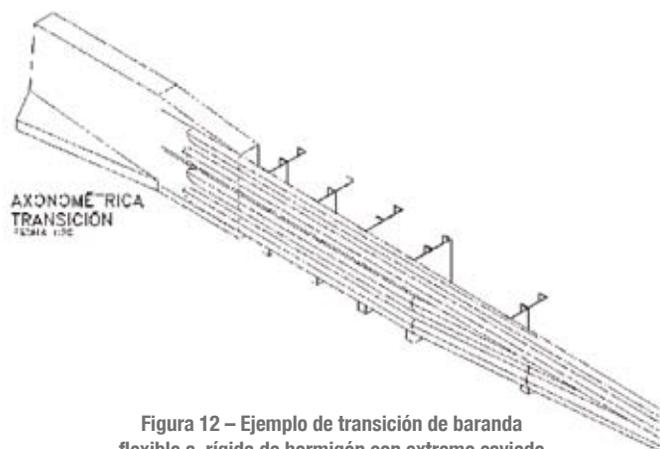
Ejemplo de transición de baranda flexible a rígida de hormigón con extremo esviado
